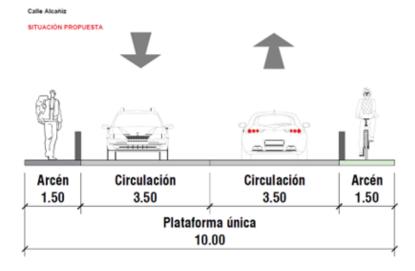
Alternativa 1 propuesta en la C. Alcañiz. Fuente: DOYMO
